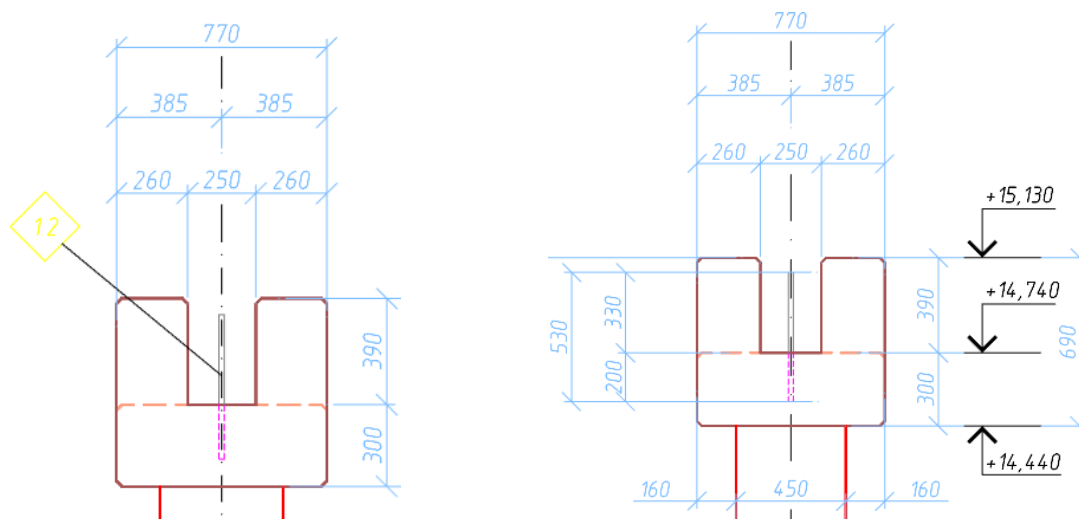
Двухмерный чертёж верхней части внутренней колонны
